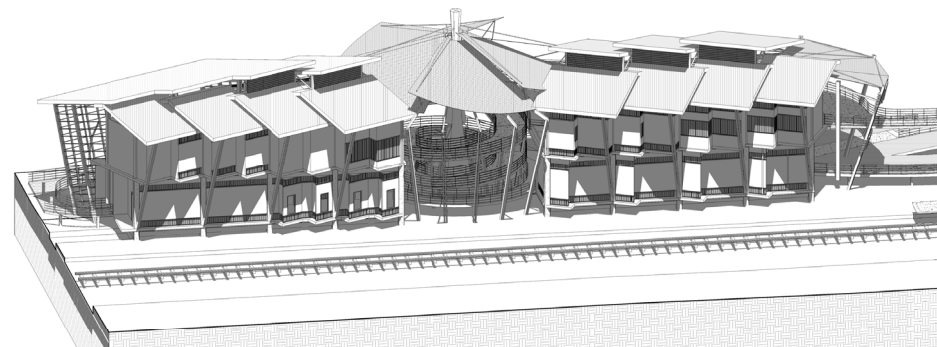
Asoleamiento en la fachada noroeste - Junio 11am.
